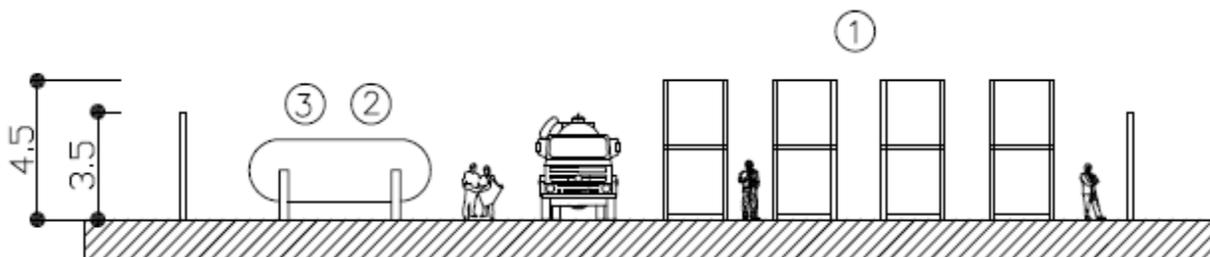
Alzado esquemático transversal de la planta generadora
